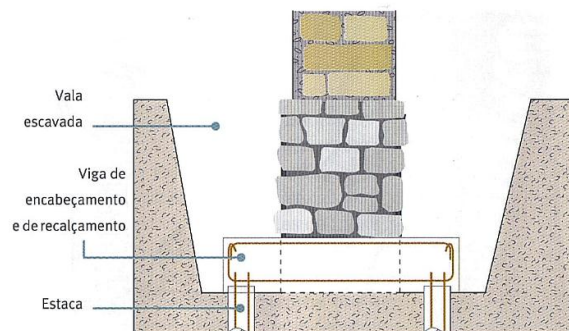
EXECUÇÃO DE ESTACAS E RECALÇAMENTO COM VIGAS DE ENCABEÇAMENTO [3].
